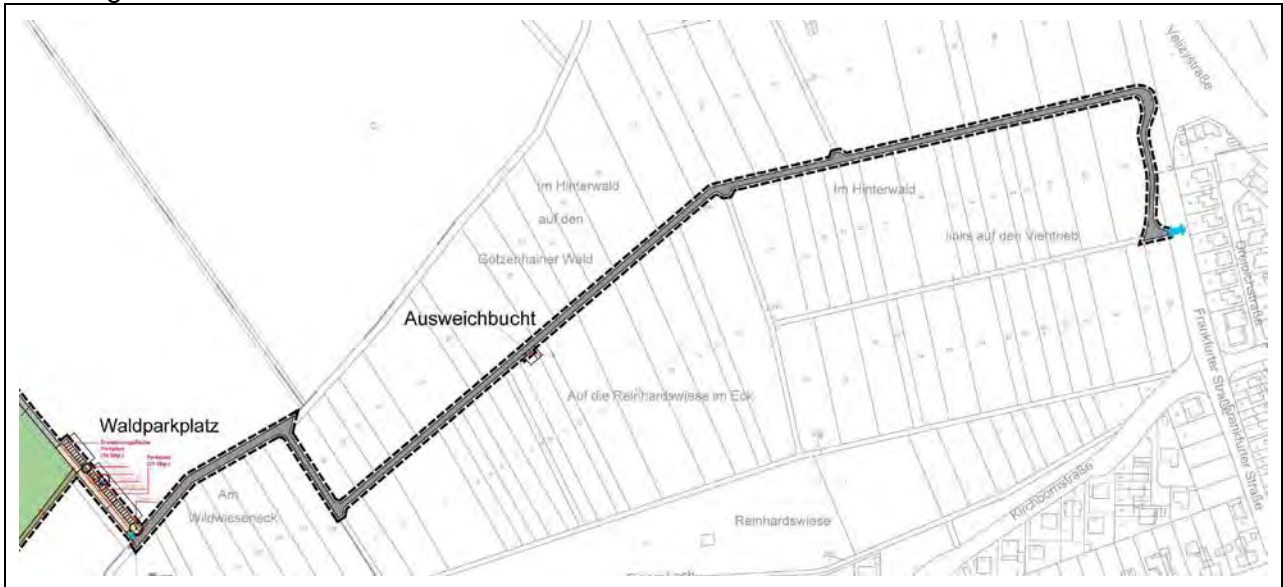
Lageplan Zufahrtsweg, o.M. Planergruppe ASL, Frankfurt
